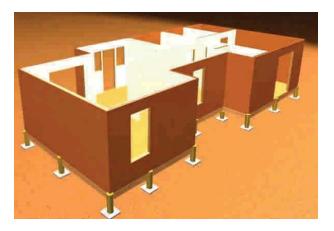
4: Primer piso de una vivienda con sus muros perimetrales alzados (tabiques soportantes).
